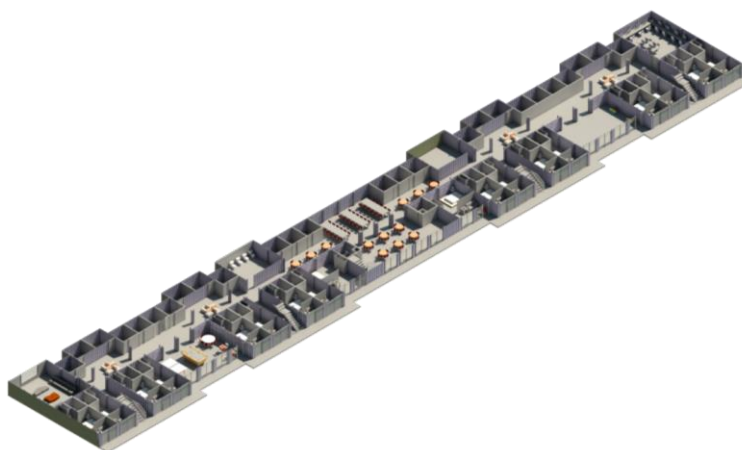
Perspectiva isométrica do primeiro pavimento – Grande bloco.
